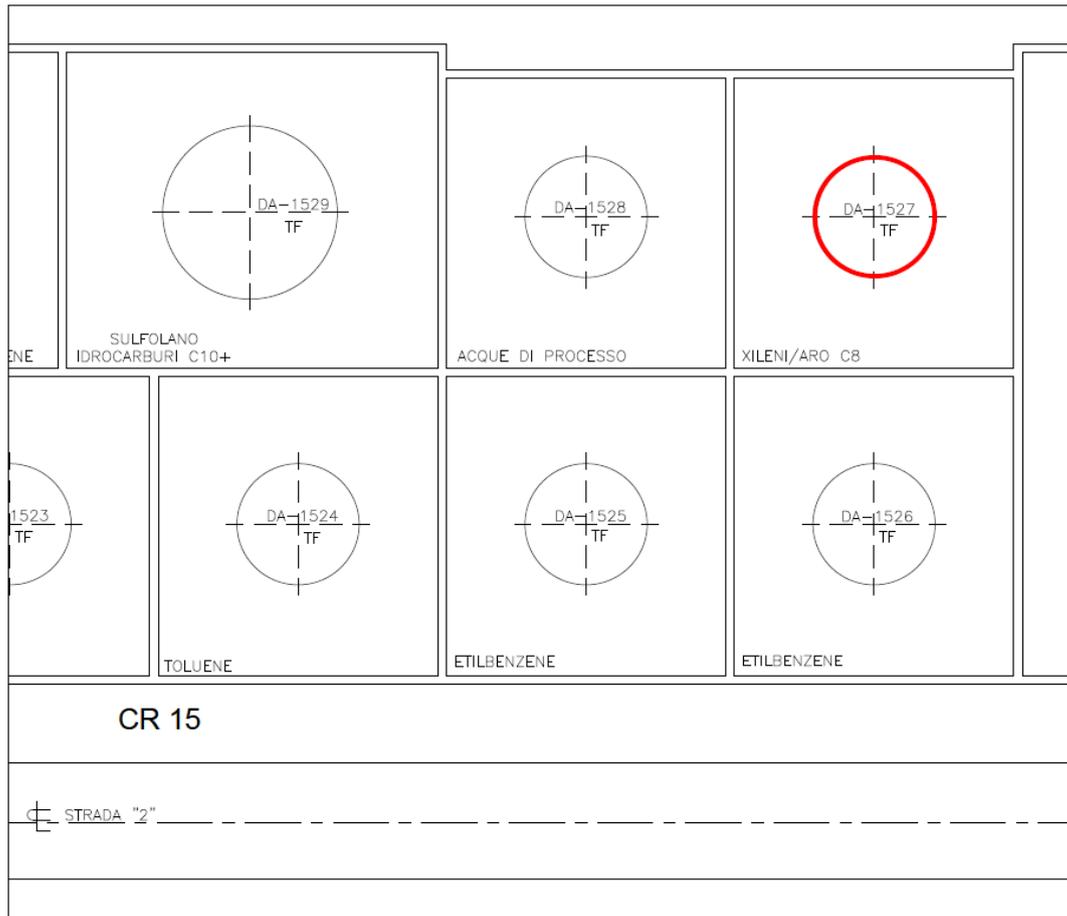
Posizionamento planimetrico serbatoio DA1527 area stoccaggi CR15 Impianti Aromatici
